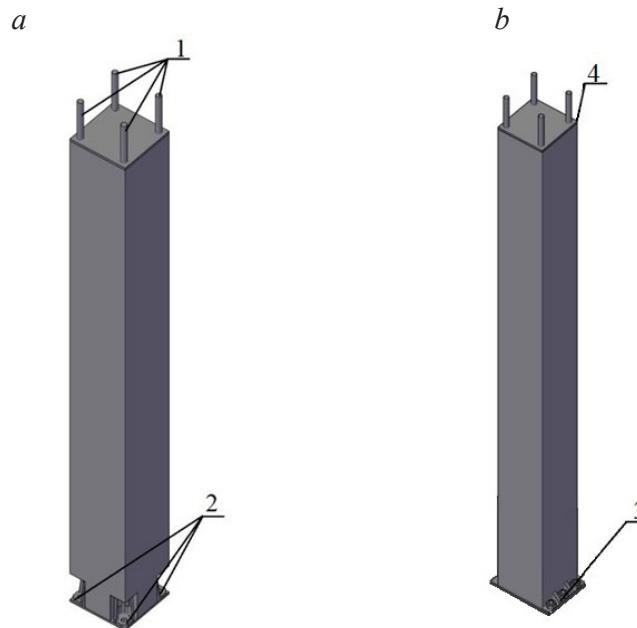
Несущие железобетонные колонны квадратного сечения:
